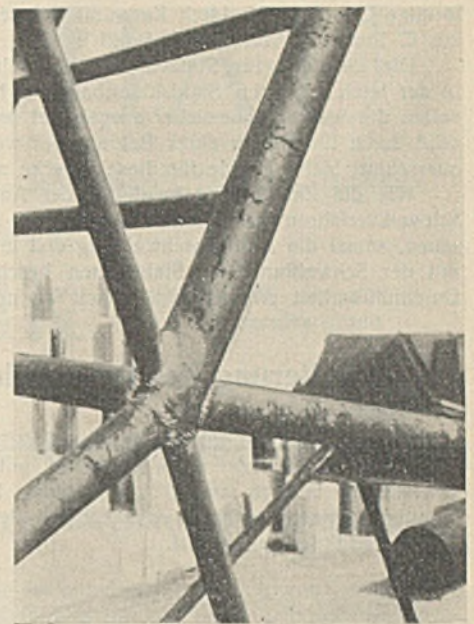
Geschweißter Knotenpunkt, in dem 6 Stäbe mit rohrförmigem Querschnitt zusammengeführt sind.
